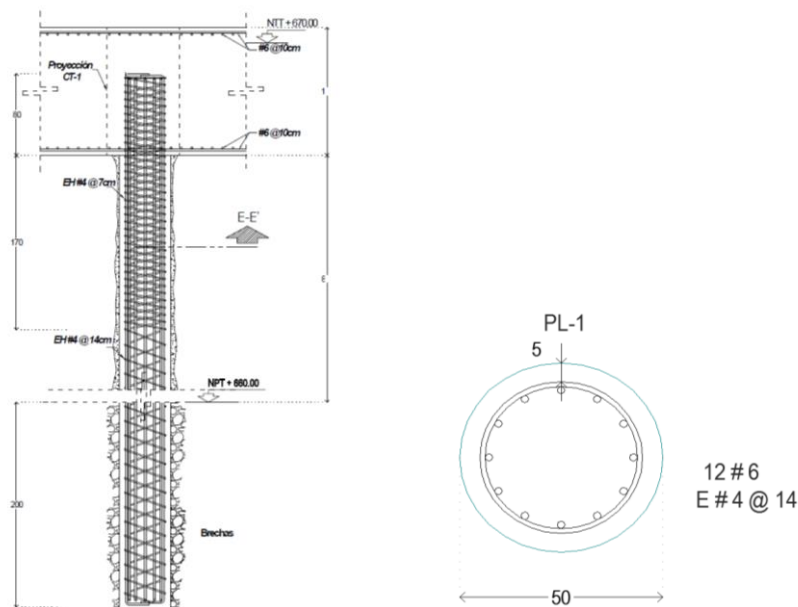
Arreglo de acero de pila de cimentación para Turbogenerador
